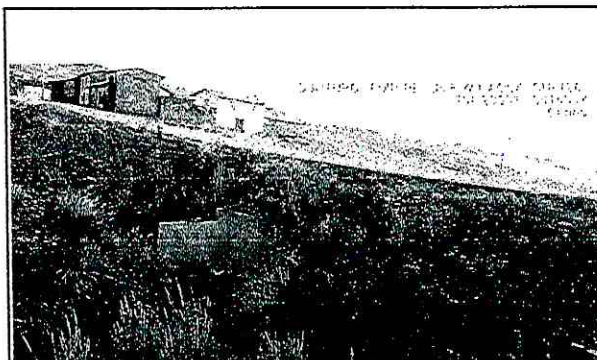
ALCANTARILLA DE CONCRETO 107+750
